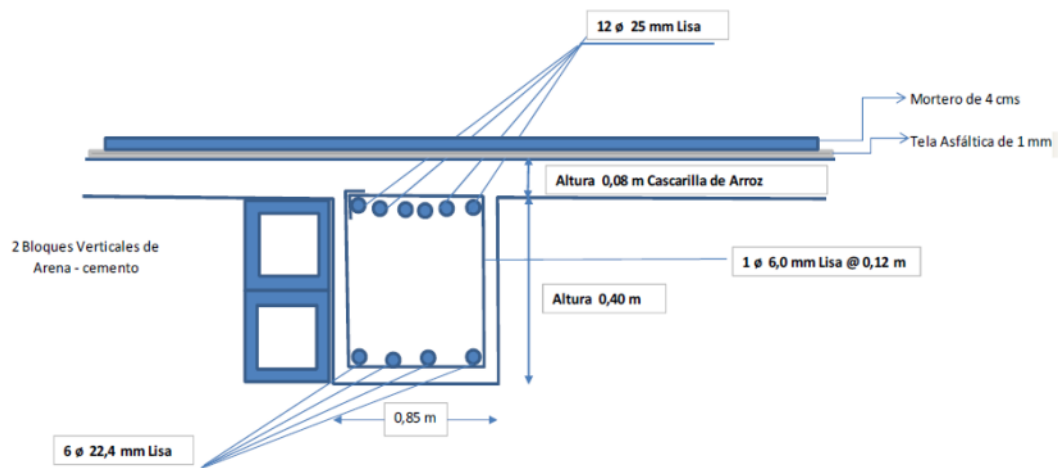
Viga 6 entre Ejes B-C Tercer Piso Segunda Placa
